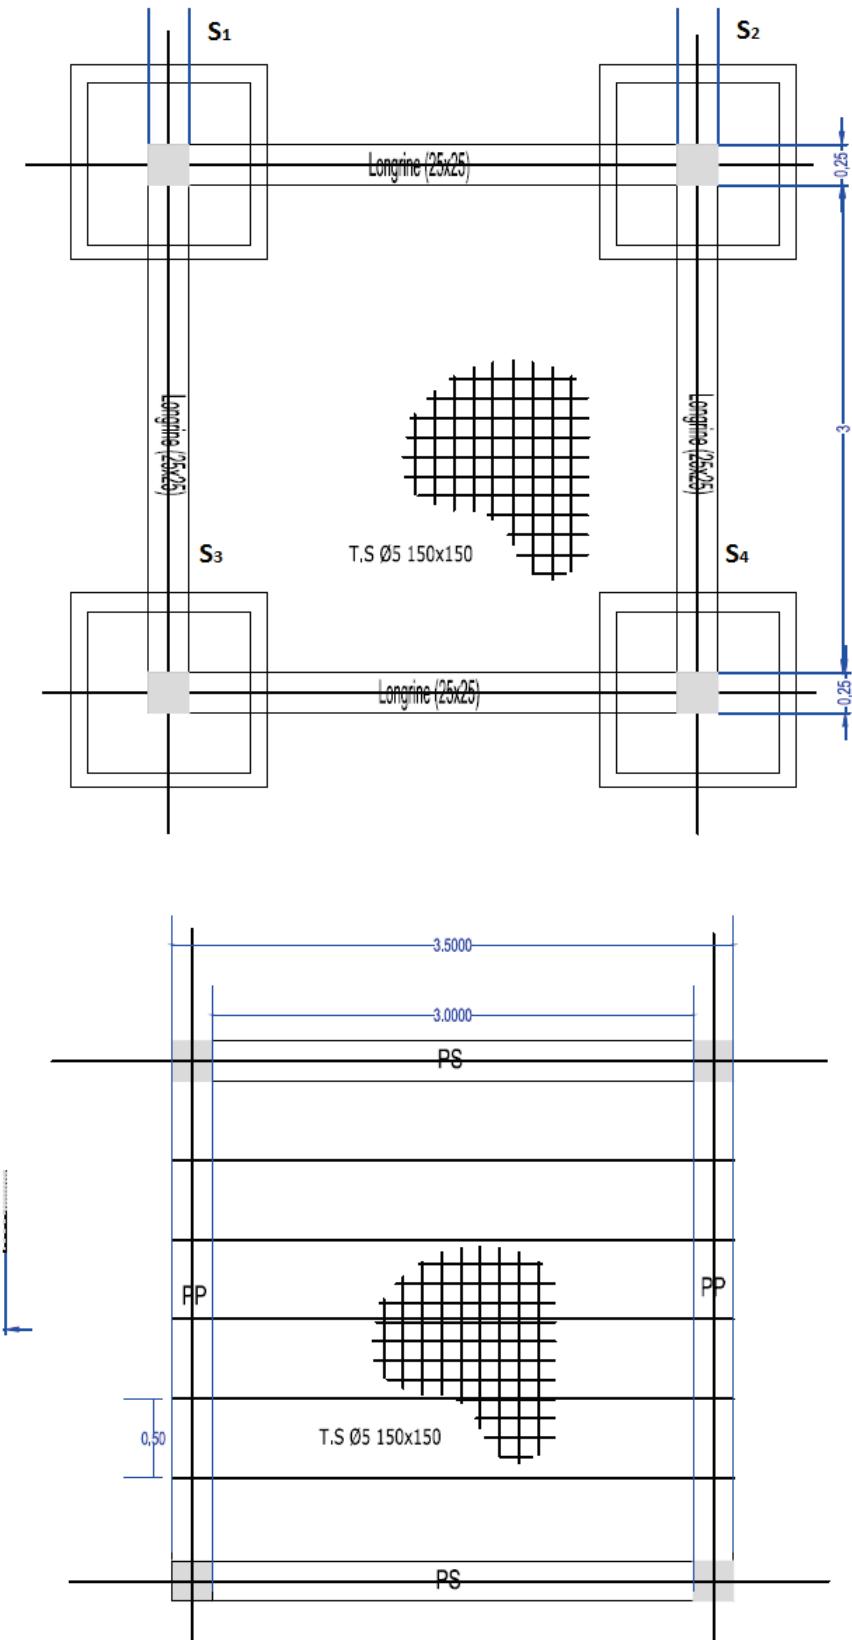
Plan de coffrage semelles, longrines et dalle
